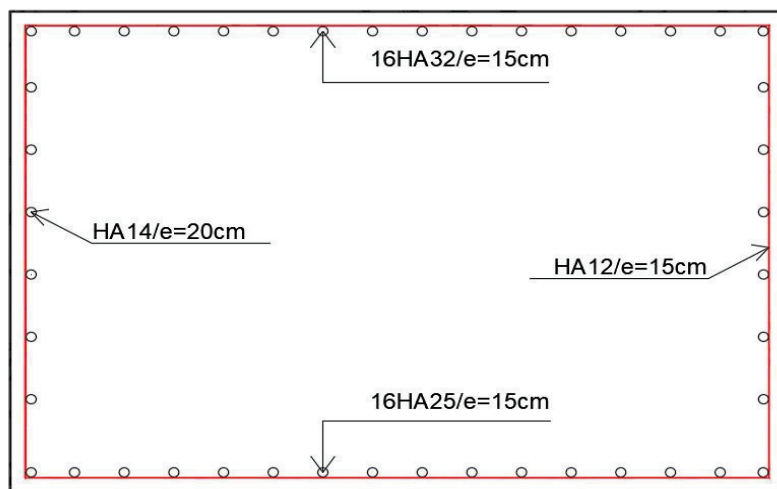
FERRAILAGE DU CHEVETRE.
